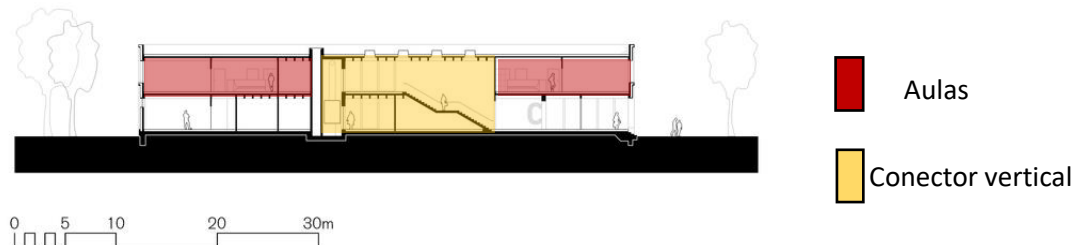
Plano de corte de proyecto. Fuente: Archdaily
